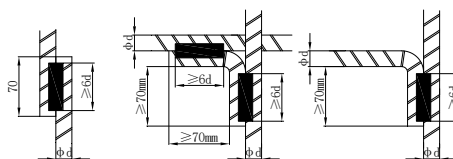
作为接闪器、引下线和接地体的混凝土内钢筋的焊接方法
